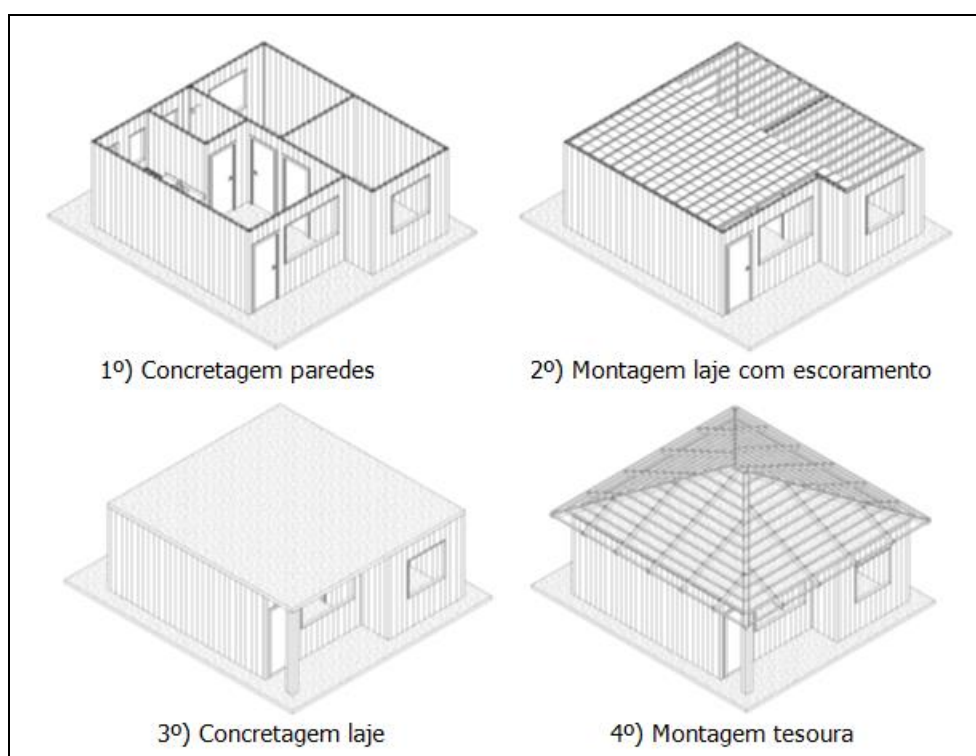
Ilustração das principais etapas de execução do sistema de cobertura constituído de laje plana de concreto e telhado. (Sem escala).
